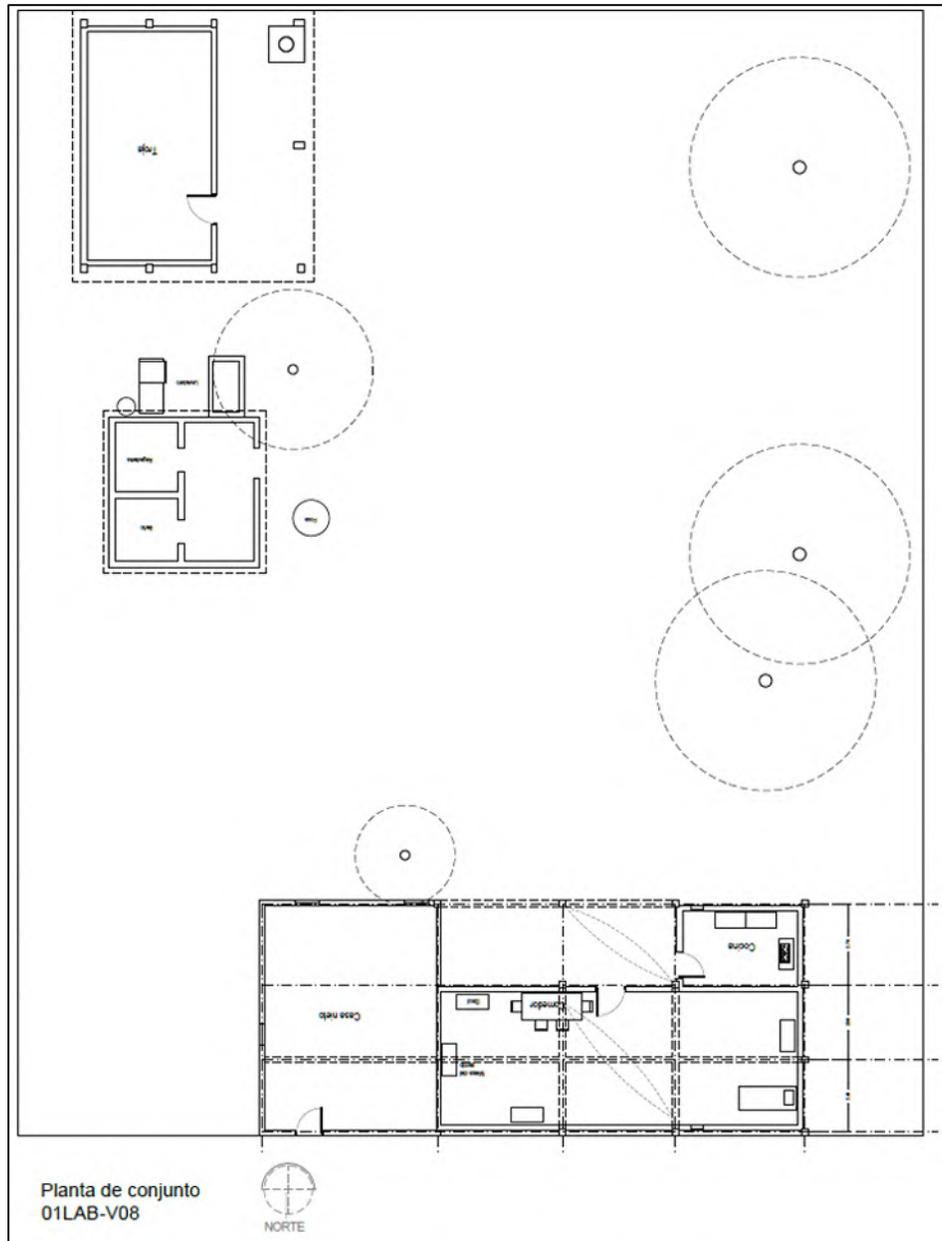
Planta de conjunto de vivienda en La Blanca. Clave:01LAB-V08. Fuente: elaboración propia.
